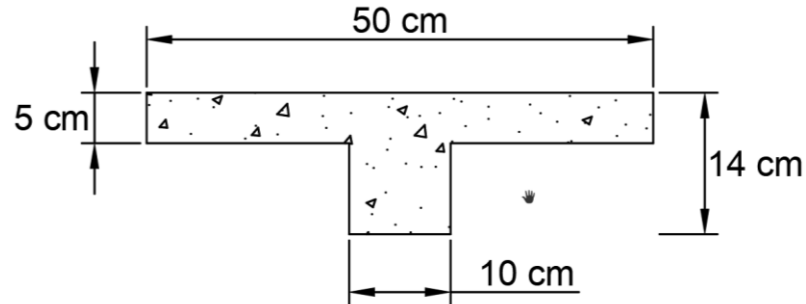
Sección de losa propuesta para entrepiso y cubierta
